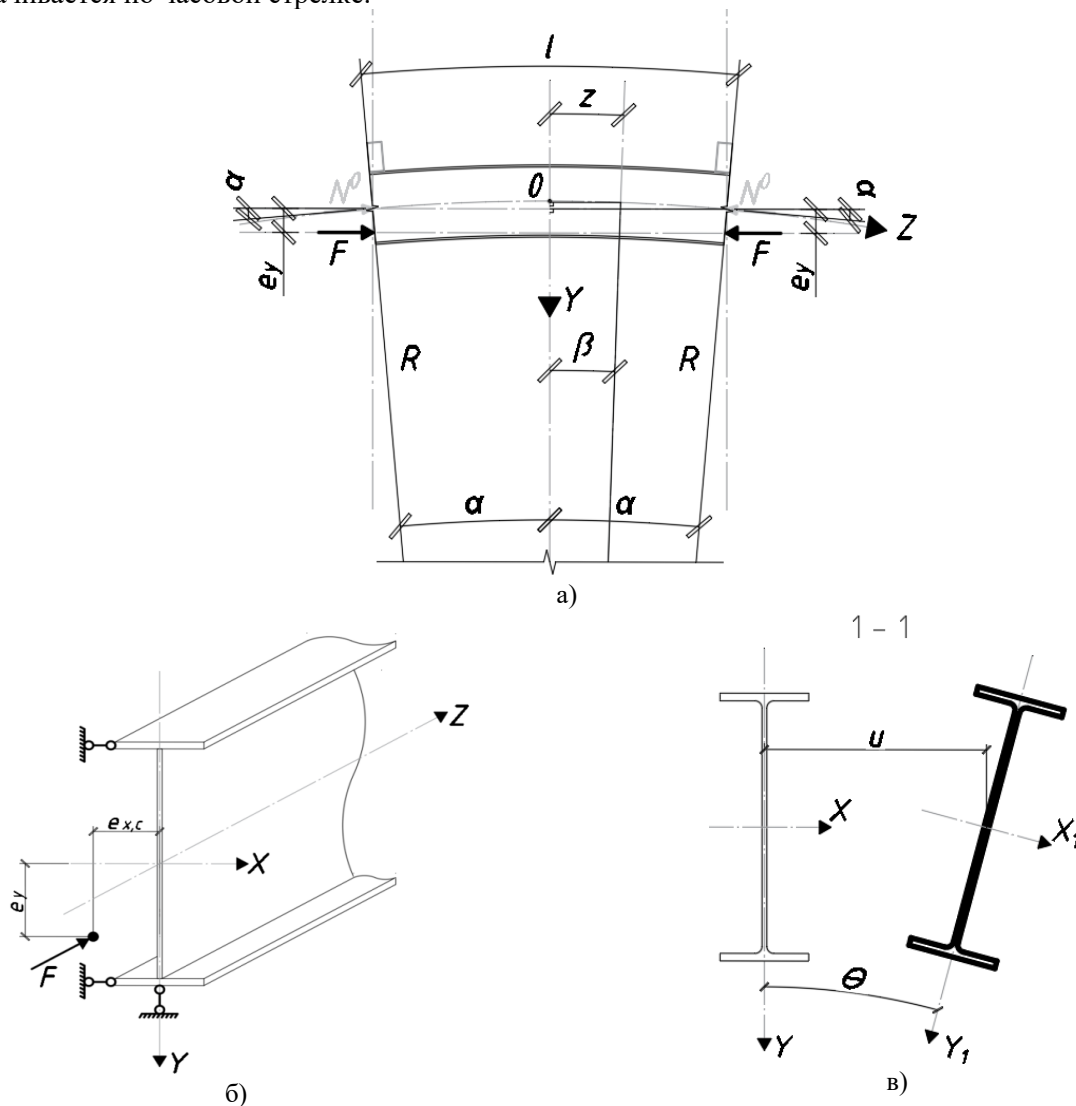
Расчетная схема: а) – схема загрузки стержня; б) – граничные условия; в) – изгибно-крутильные перемещения сечения;
